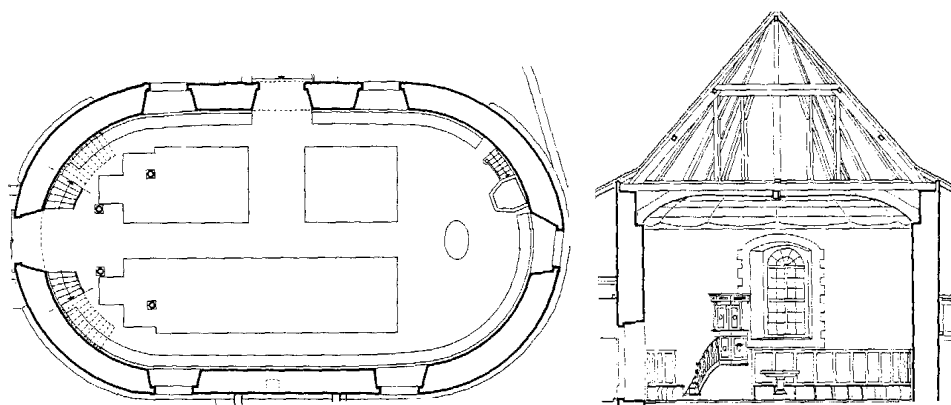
Plan et coupe du temple ovale de Oron-la-Ville (1679) [49]
